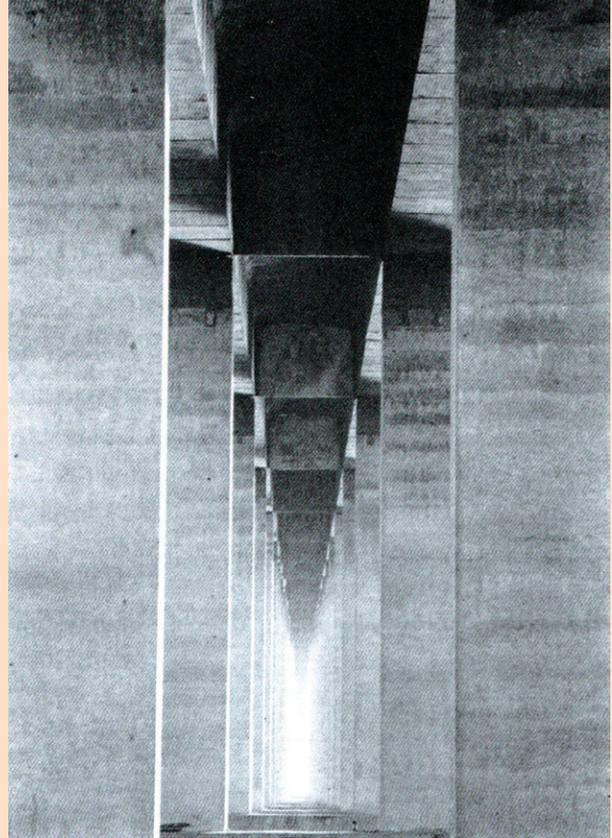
VISTA LONGITUDINAL INFERIOR DA PONTE ENTRE OS PILARES. É COMO O FOTÓGRAFO ROBERT OSTROVSKI DEVE TER IMAGINADO O CAMINHO QUE CONDUZ AO CÉU, CAMINHANDO ENTRE OS PILARES DE UMA CATEDRAL CELESTIAL... [12]
